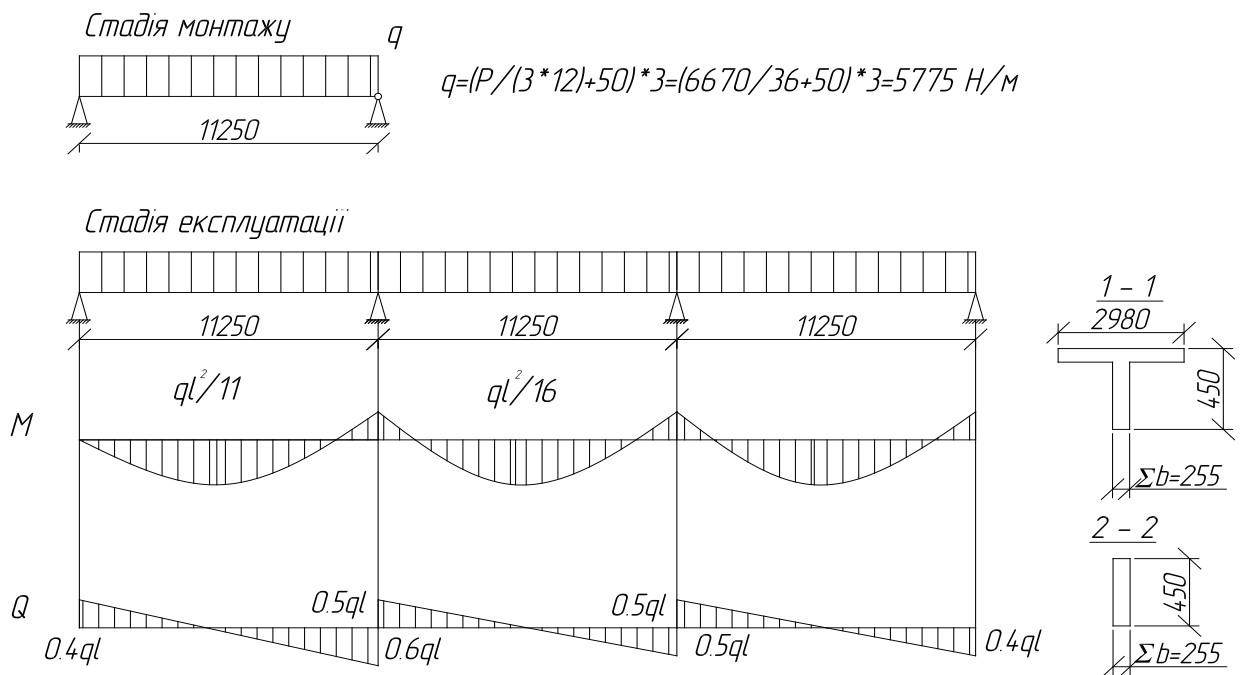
Розрахункові схеми плити в стадії монтажу і експлуатації
